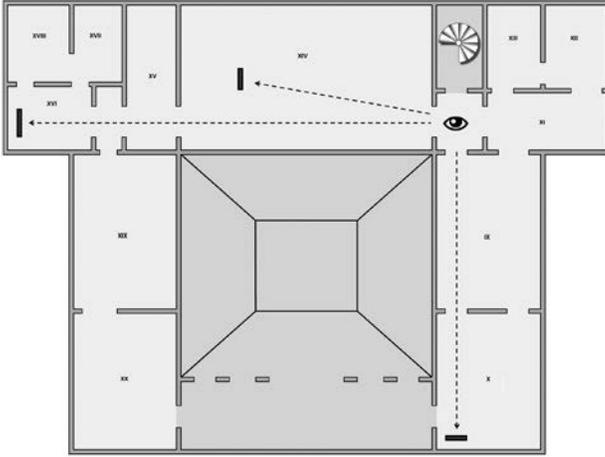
Planimetria del primo piano della Galleria Borghese con la disposizione delle opere di Mat Collishaw.
